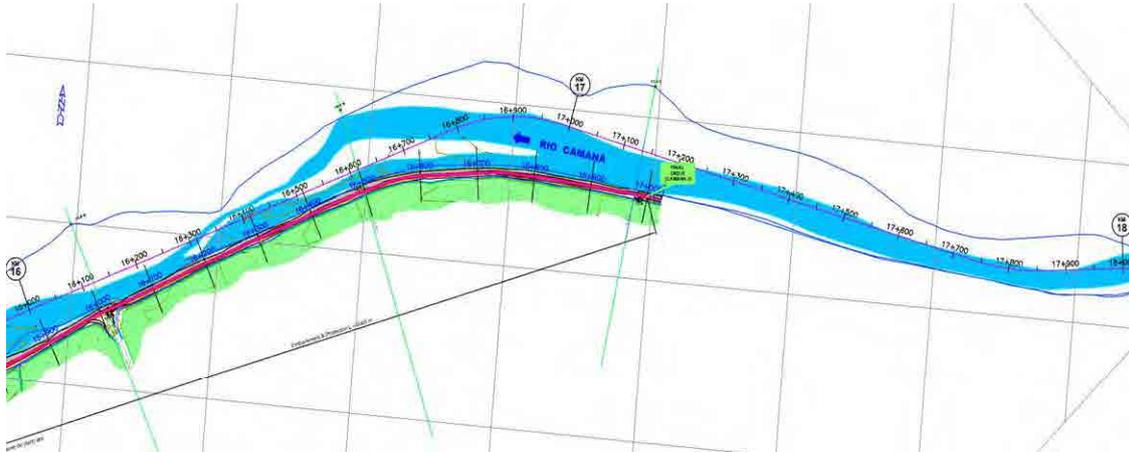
Planta de instalaciones Caman-3 (4)
